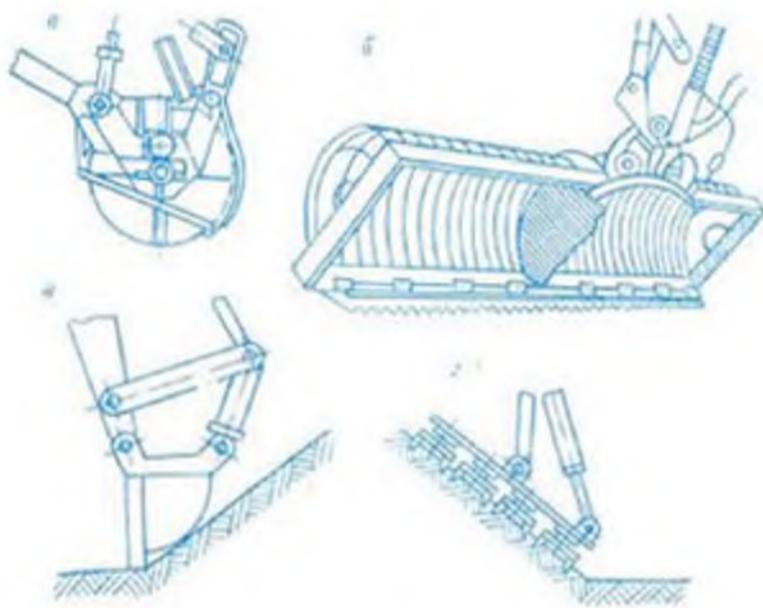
Каналоочистители со сменными рабочими органами. Схемы сменных рабочих органов: а — роторного; б — ковш-косилки; в — уширенного ковша обратной лопаты; г — механизма для стабилизации откосов.
